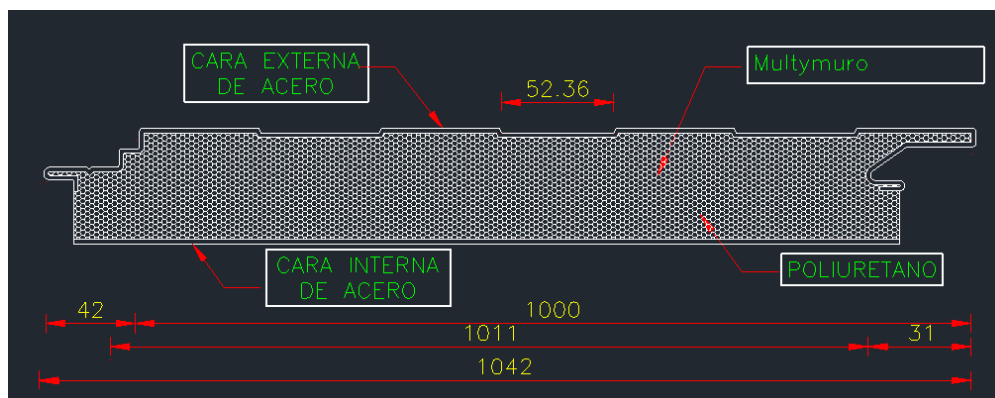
Detalle Multymuro (Disciplina de Estructuras).
